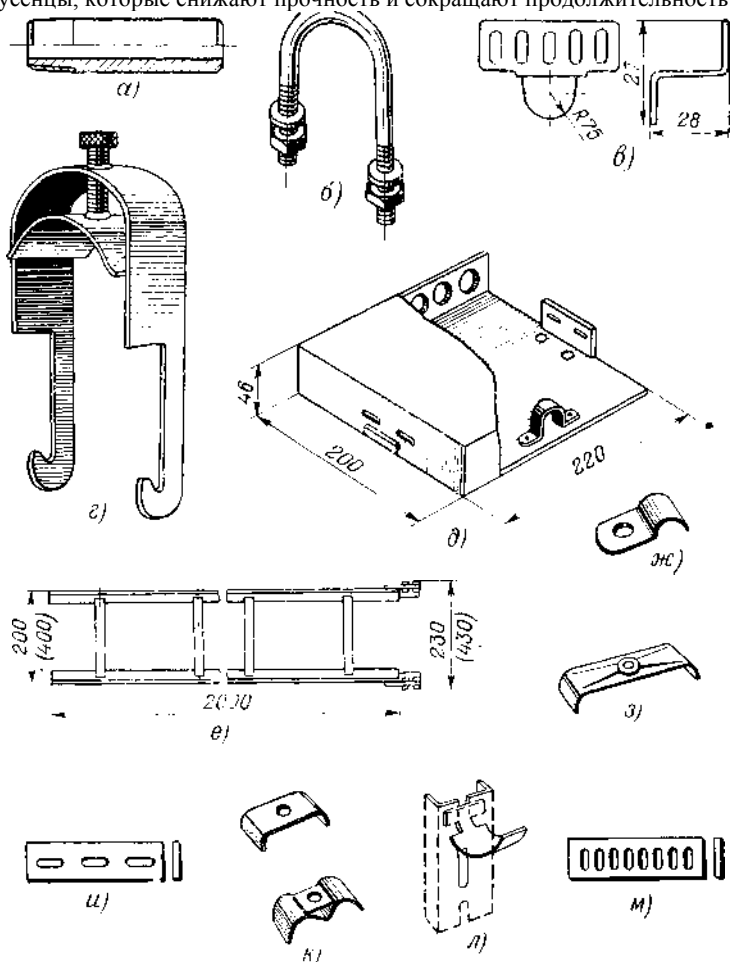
Изделия для монтажа трубных проводов. а — футорка для перехода защитных трубопроводов с большего диаметра на меньший; б — хомут для крепления трубных проводов; в — стойка перфорированная; г — прижим типа ПКТ; д — коробка соединительная для трубных кабелей; е — лоток сварной для прокладки трубных проводов и трубных кабелей; ж — скобы однолапковые; з — скобы безлапковые для крепления двух труб или кабелей; и — скобы безлапковые для крепления пакета труб или кабелей; л — кабельные подвесы; и и м — перфорированные полосы с продольной и поперечной перфорацией
